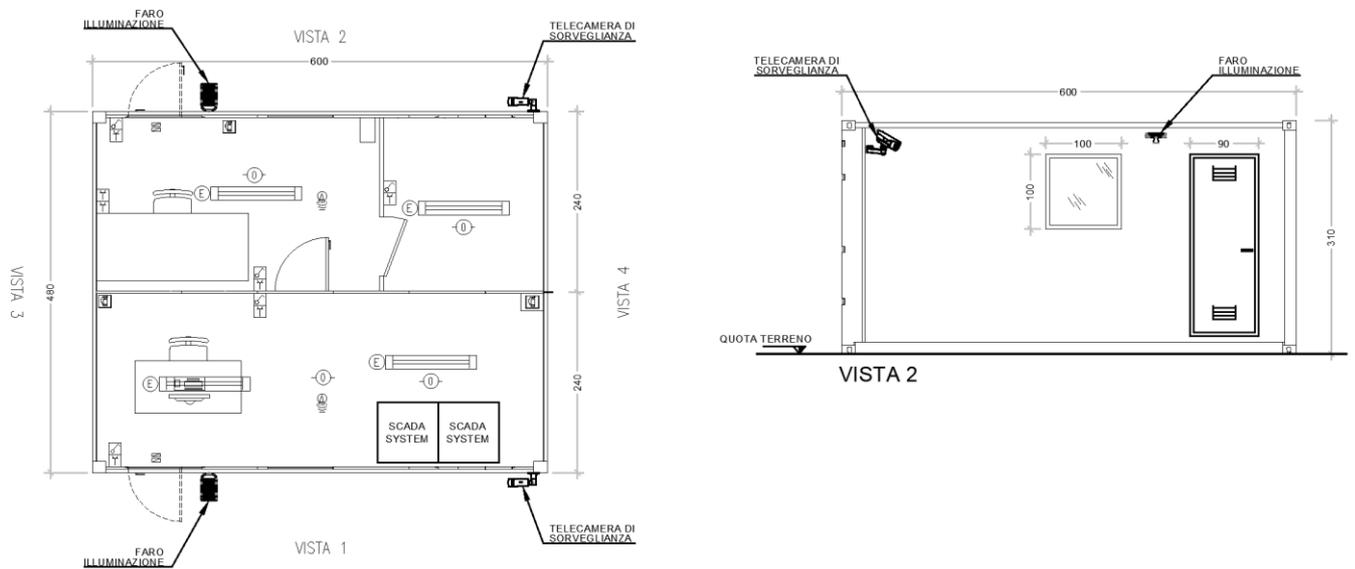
Planimetria e prospetti cabina Uffici con illuminazione e videosorveglianza
